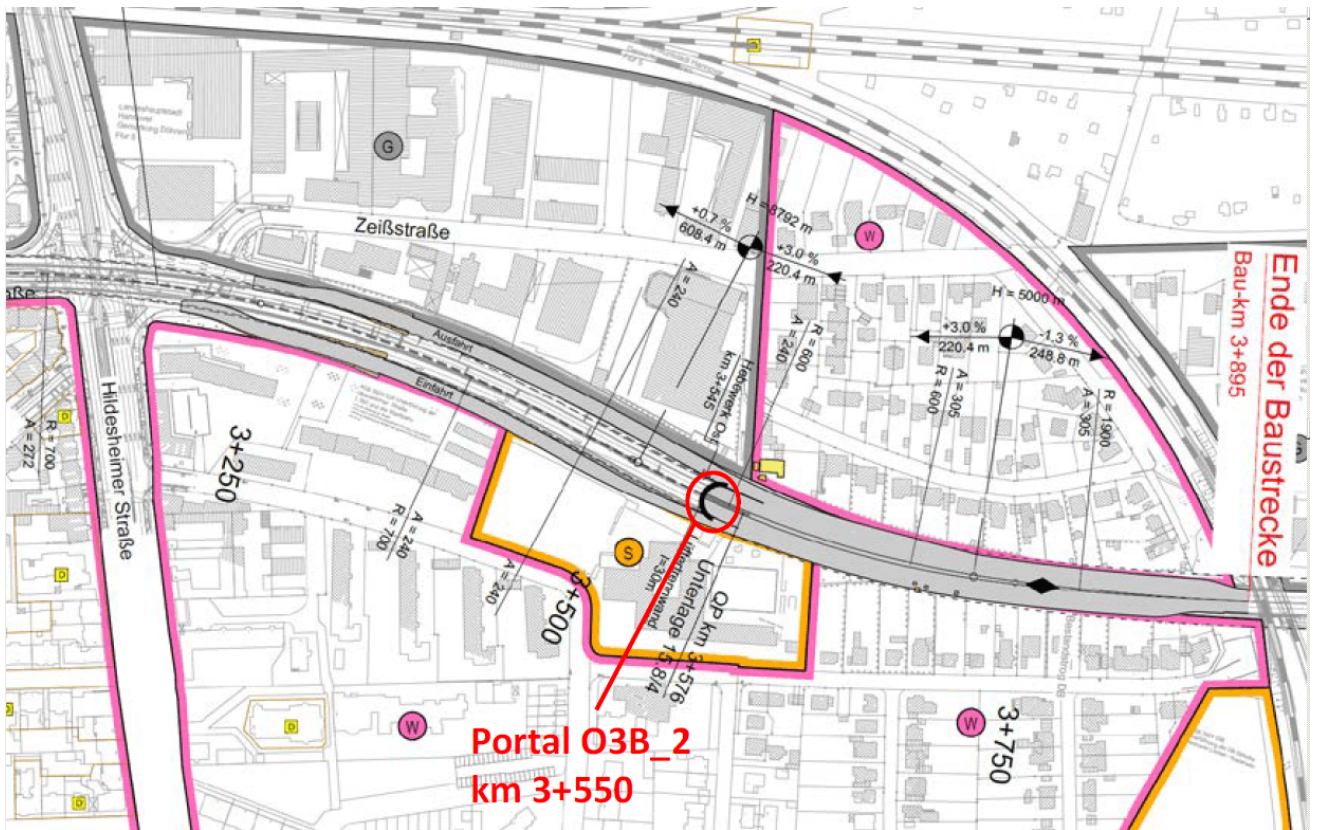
Lageplanskizze Planvariante O3B_2 [20].
